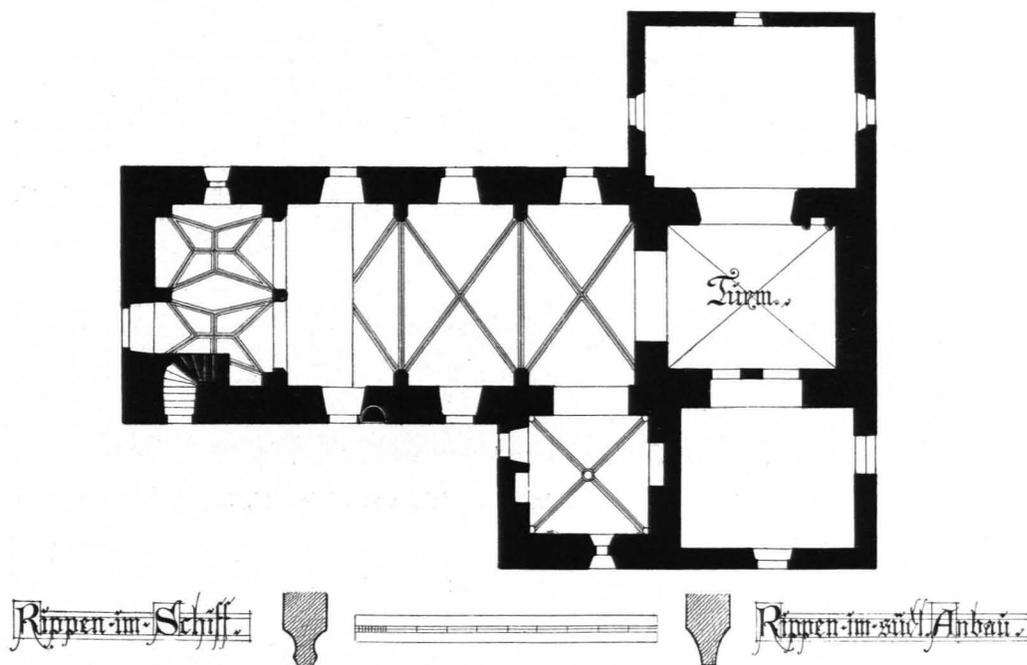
Echsenbach, Pfarrkirche, Grundriß, 1 : 250 (S. 30)
